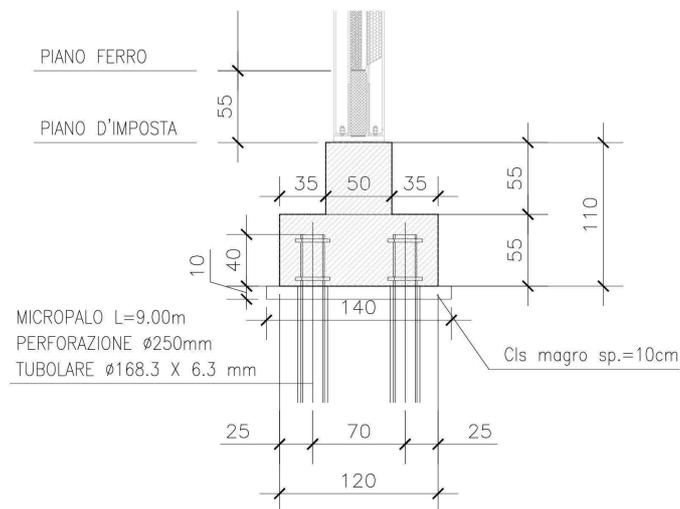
sezione fondazione di linea BFA (BA16-BA17)
